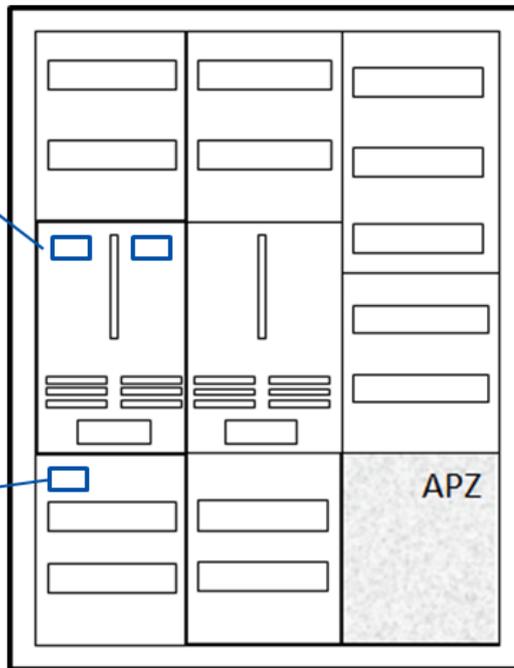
Inbetriebsetzung einschließlich Kennzeichnung einer Anschlussnutzeranlage
